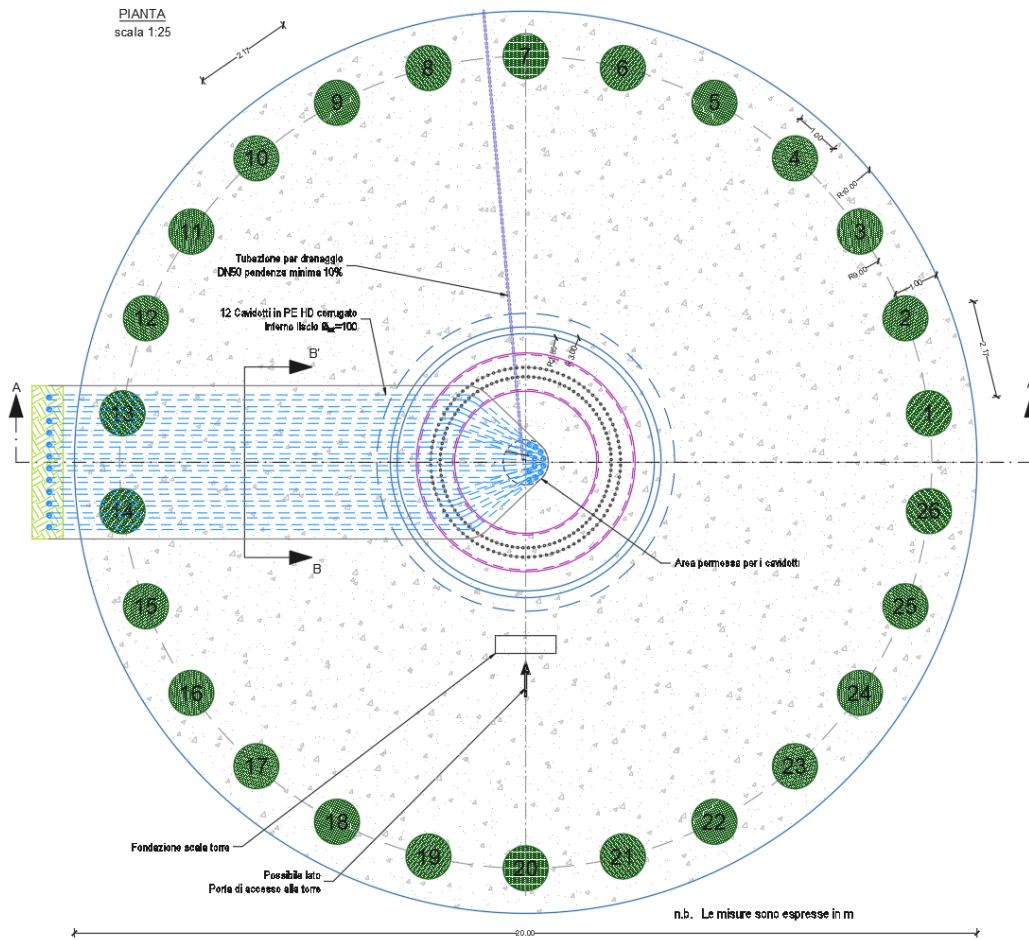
Pianta del plinto con indicazione dei pali di fondazione (n.26 del diametro 1000mm)
